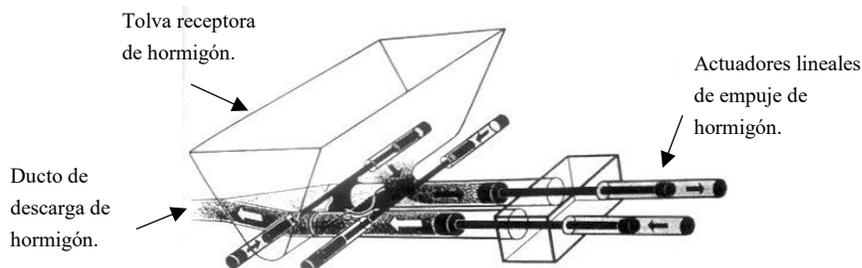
Bomba hormigonera, donde los actuadores hidráulicos, son los encargados de desplazar el concreto.
